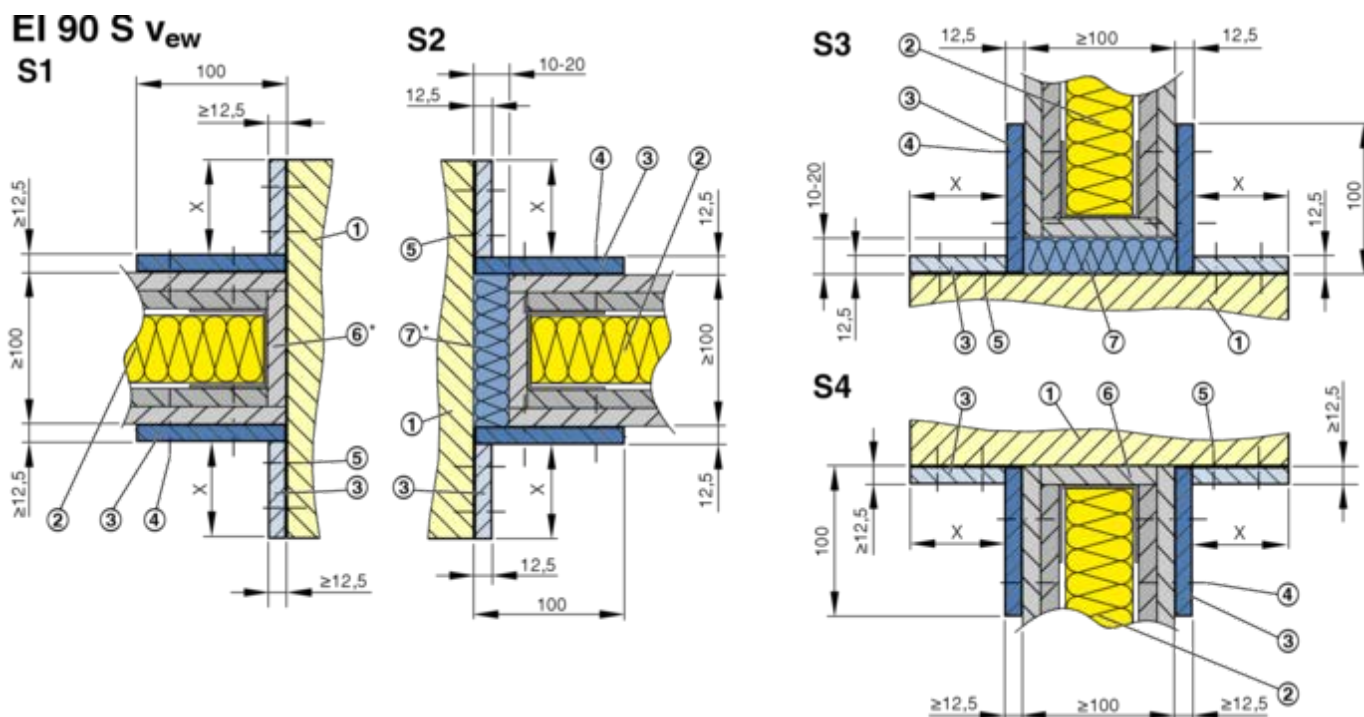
Dettagli installazione a secco senza malta EK-JZ in una parete piena, parete piena con intercapedine EI 90 S
